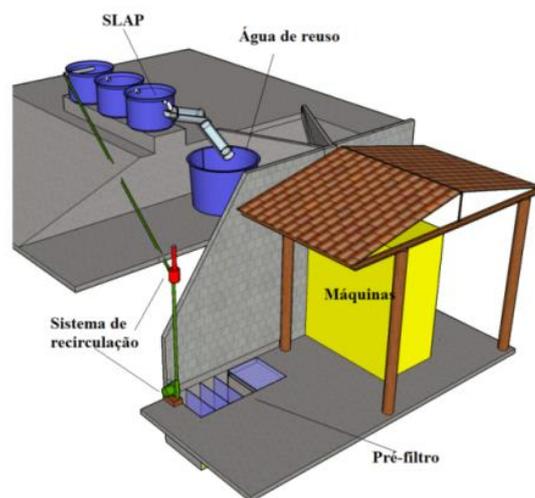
Instalação do SLAP a montante das instalações de preparo.
